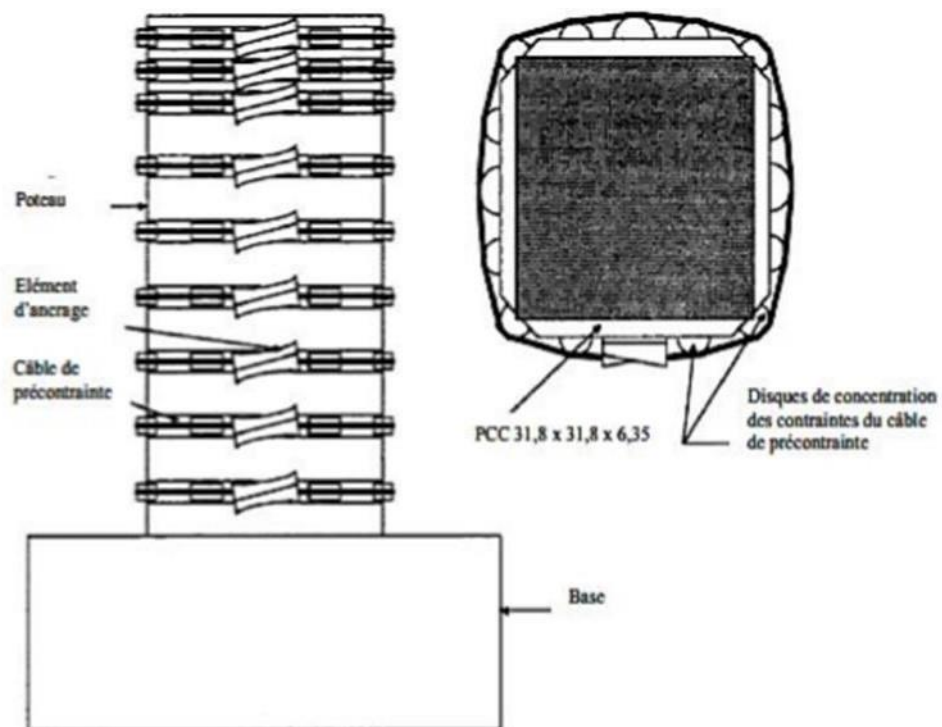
Détail d'un renforcement d'un poteau carré par précontraintes additionnelles. [(Kherkhache S). 2013]
